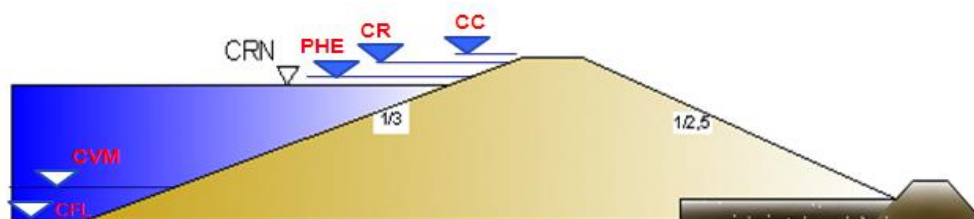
5 schéma des différents hauteurs d'un barrage en terre
